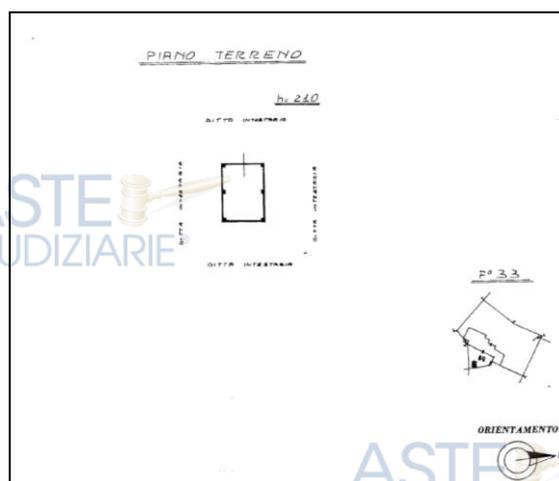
Estratto planimetria catastale nella quale si vede l'autorimessa e la sua collocazione un tempo nel cortile davanti al fabbricato residenziale
